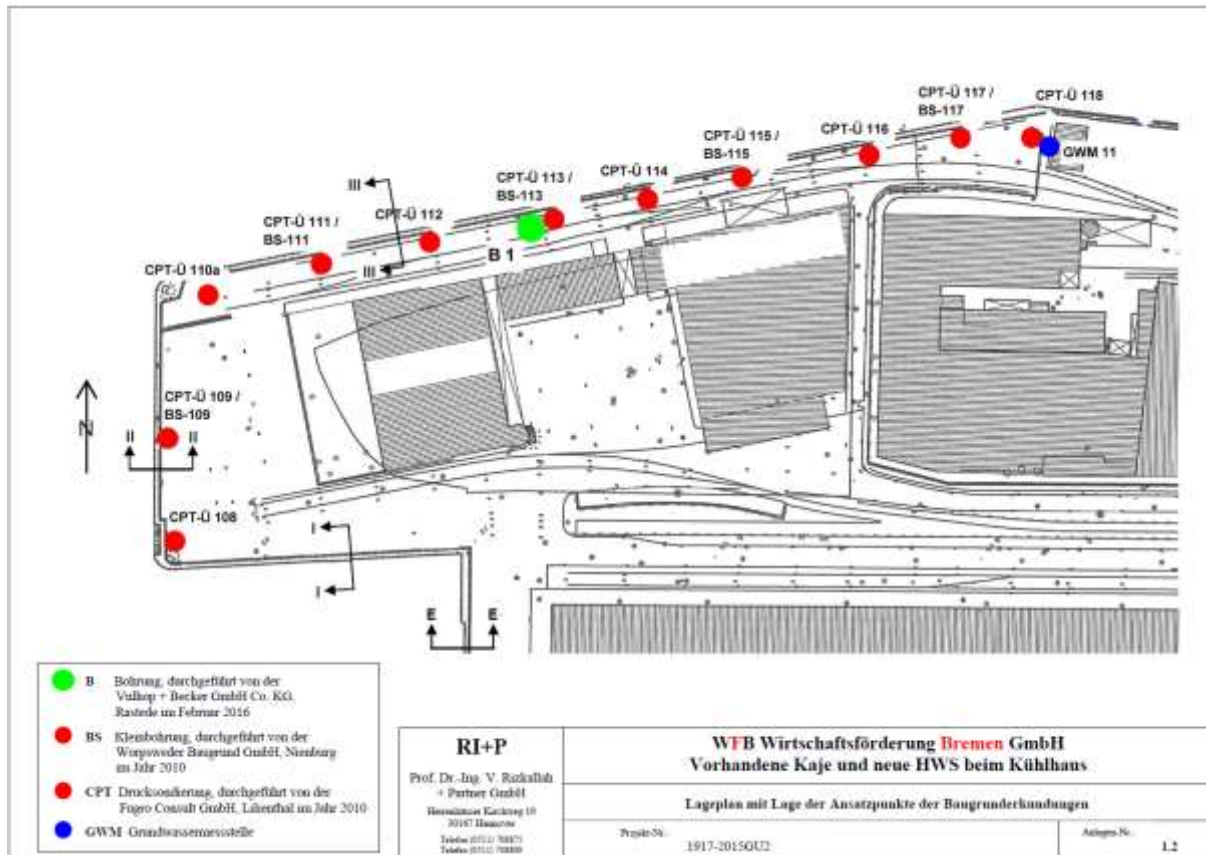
Lage der Baugrunderkundungen / Bemessungsprofile (Auszug aus [U3])
